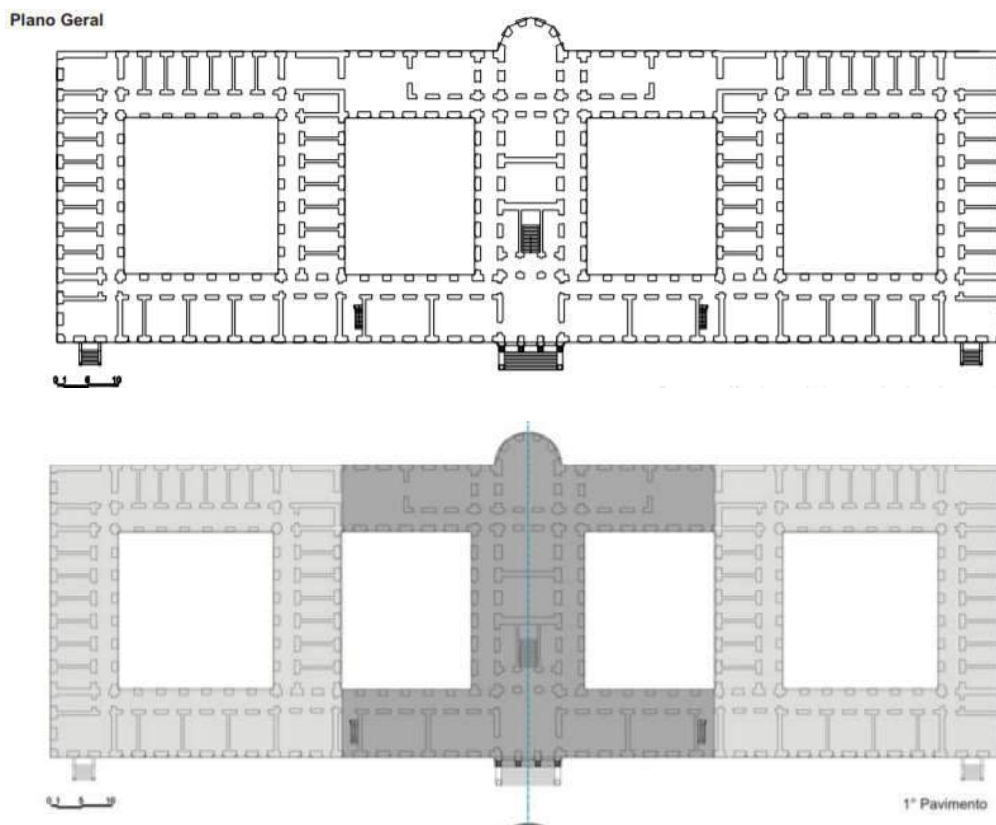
e 42. Planta do 1º pavimento do Hospício Pedro II, segundo sua concepção original.
